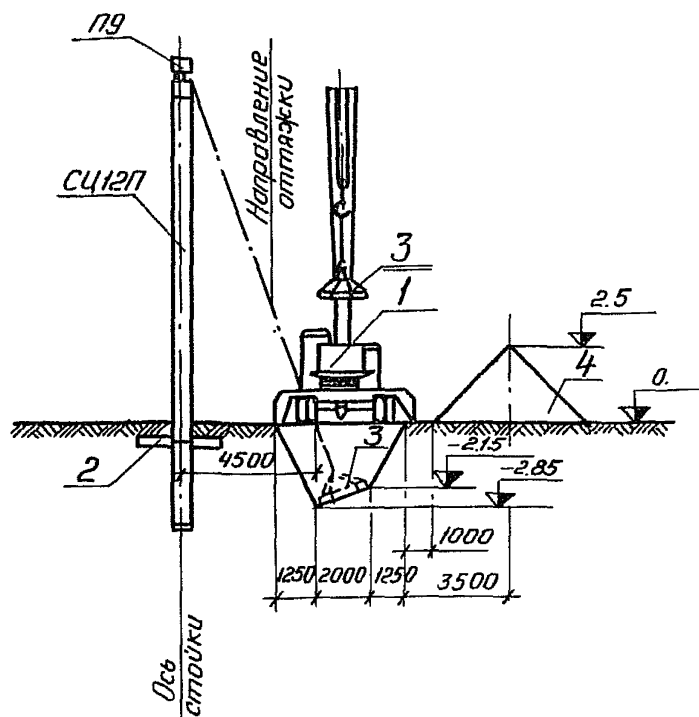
Разрез II-II на стадии монтажа анкерных плит:
